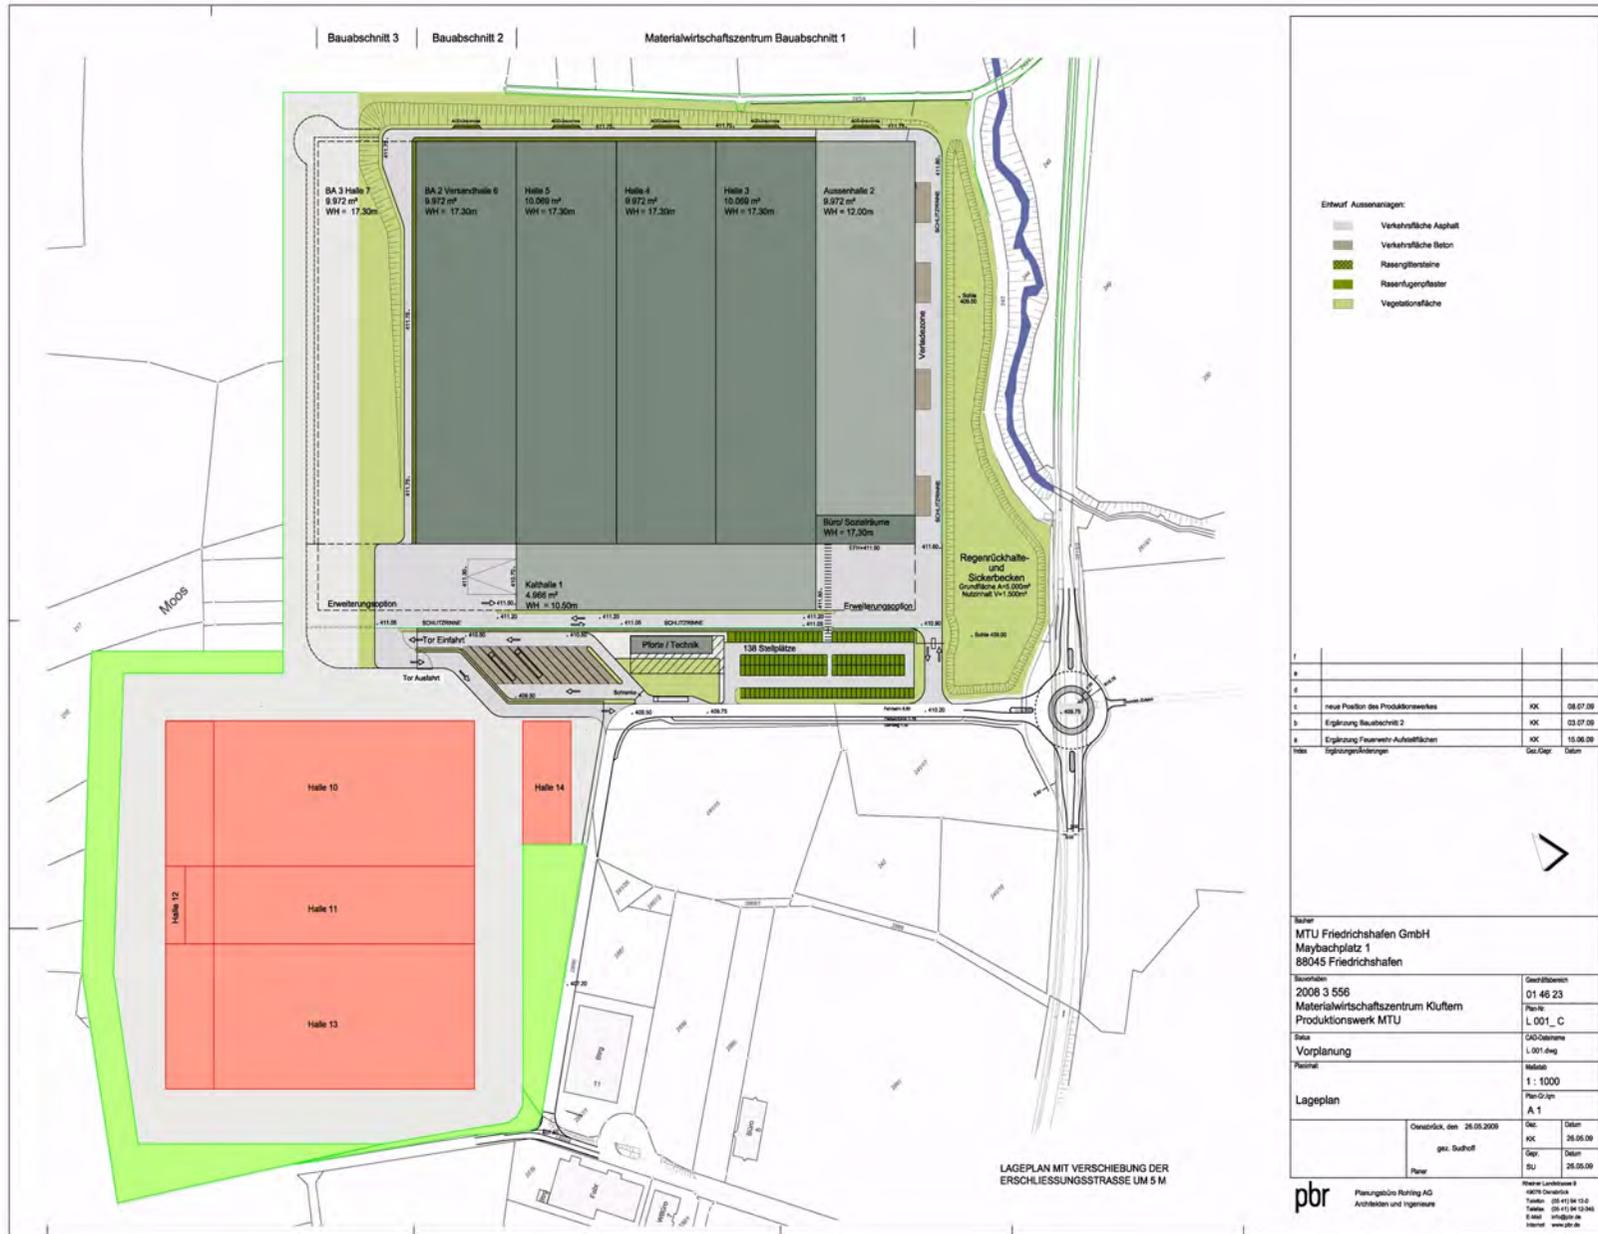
Flächenlayout MTU (MWZ und Montagewerk) im Endzustand (pbr; im Auftrag der MTU, Mai 2009)
